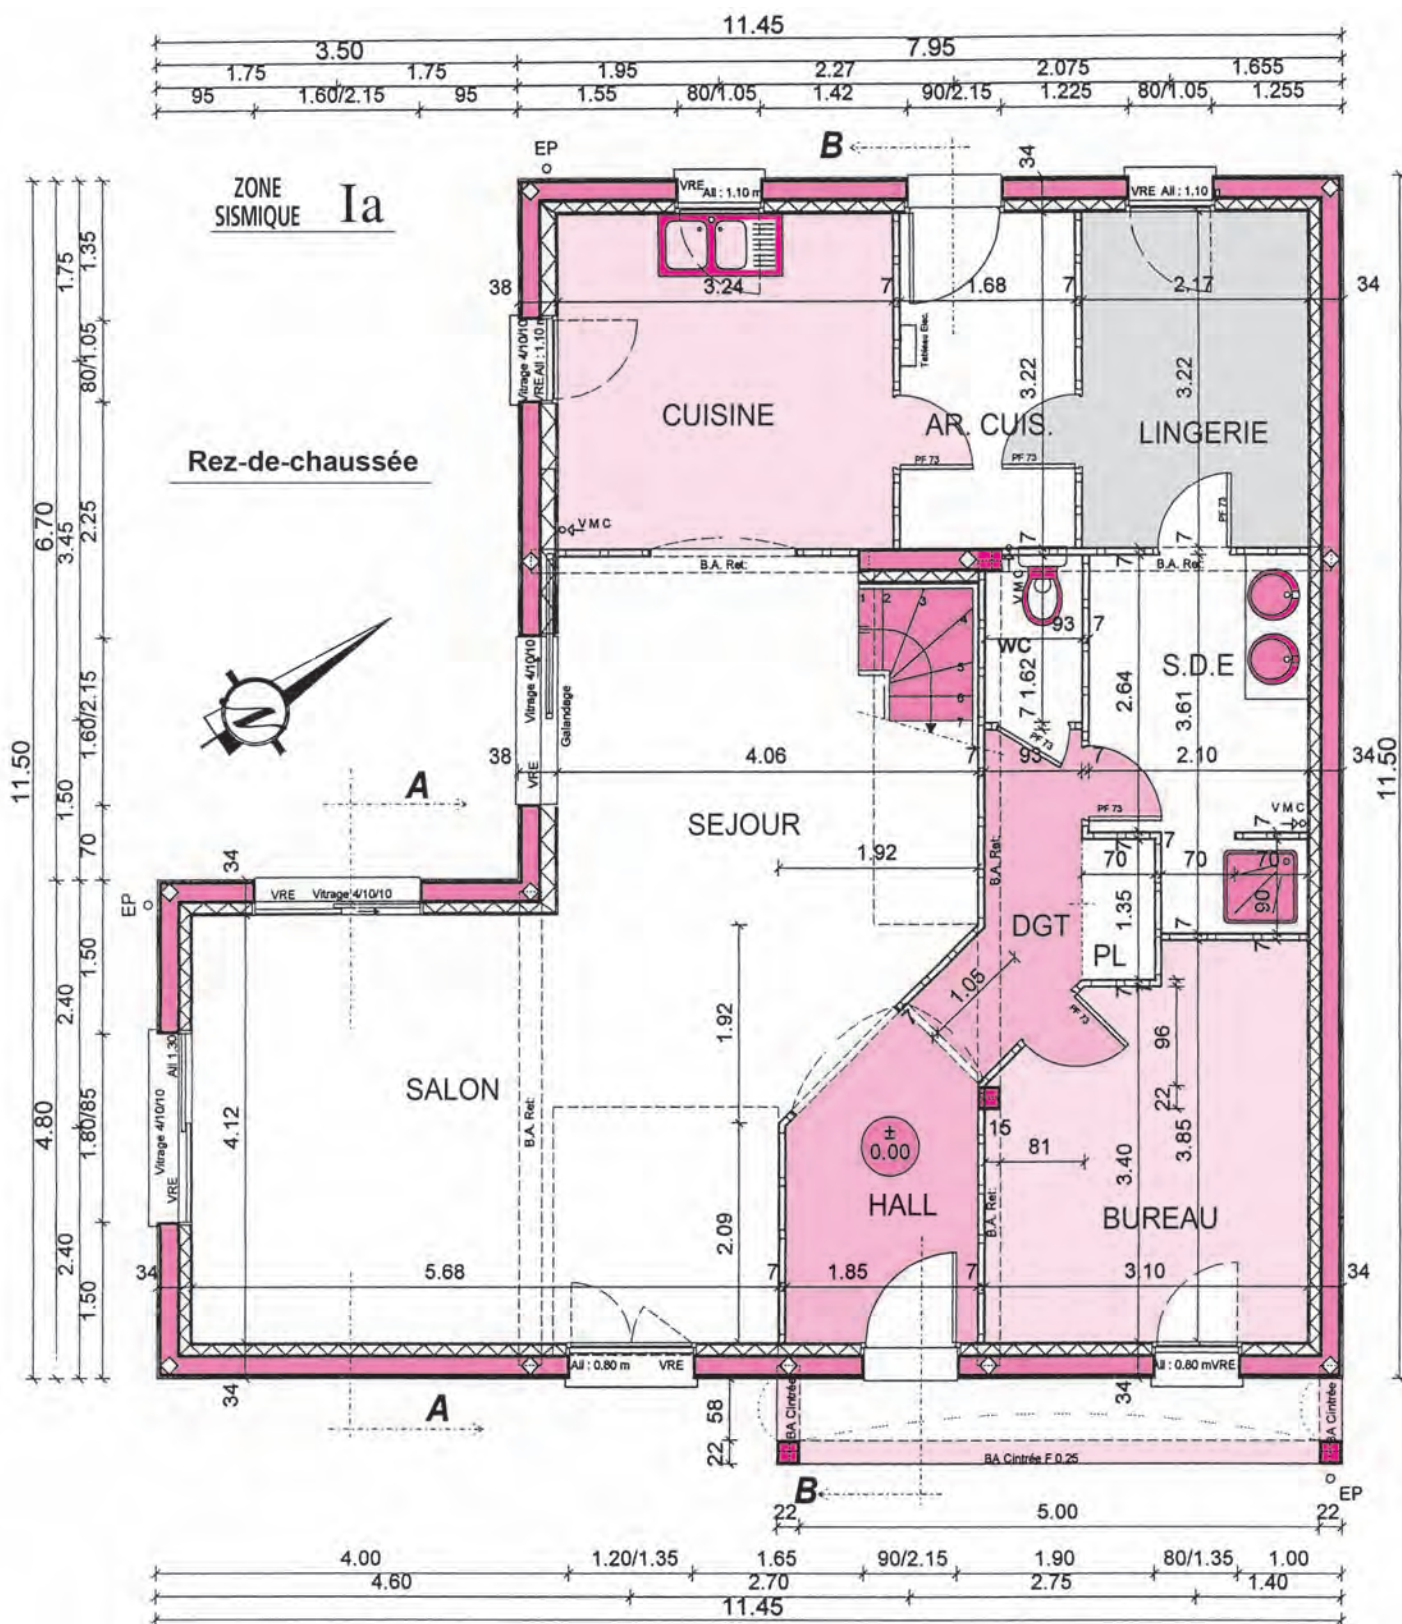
Plan du rez-de-chaussée disposé en forme de L et structure porteuse
